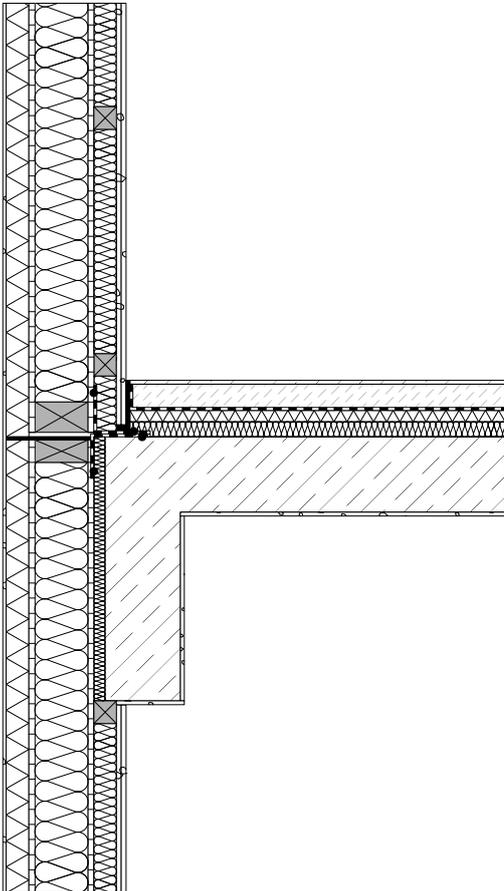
Anschluss Außenwand WA1-3 - Geschossdecke DE1 mit Randunterzug
